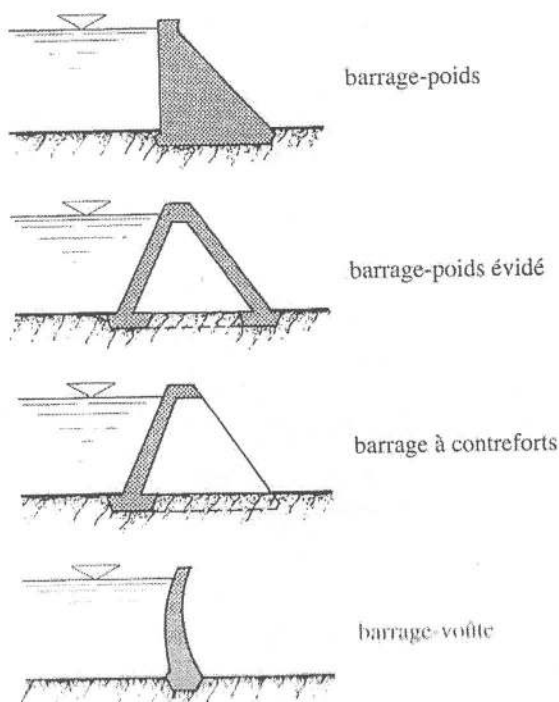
Coupes types des barrages en béton (Schleiss et Pougatsh, 2011)
